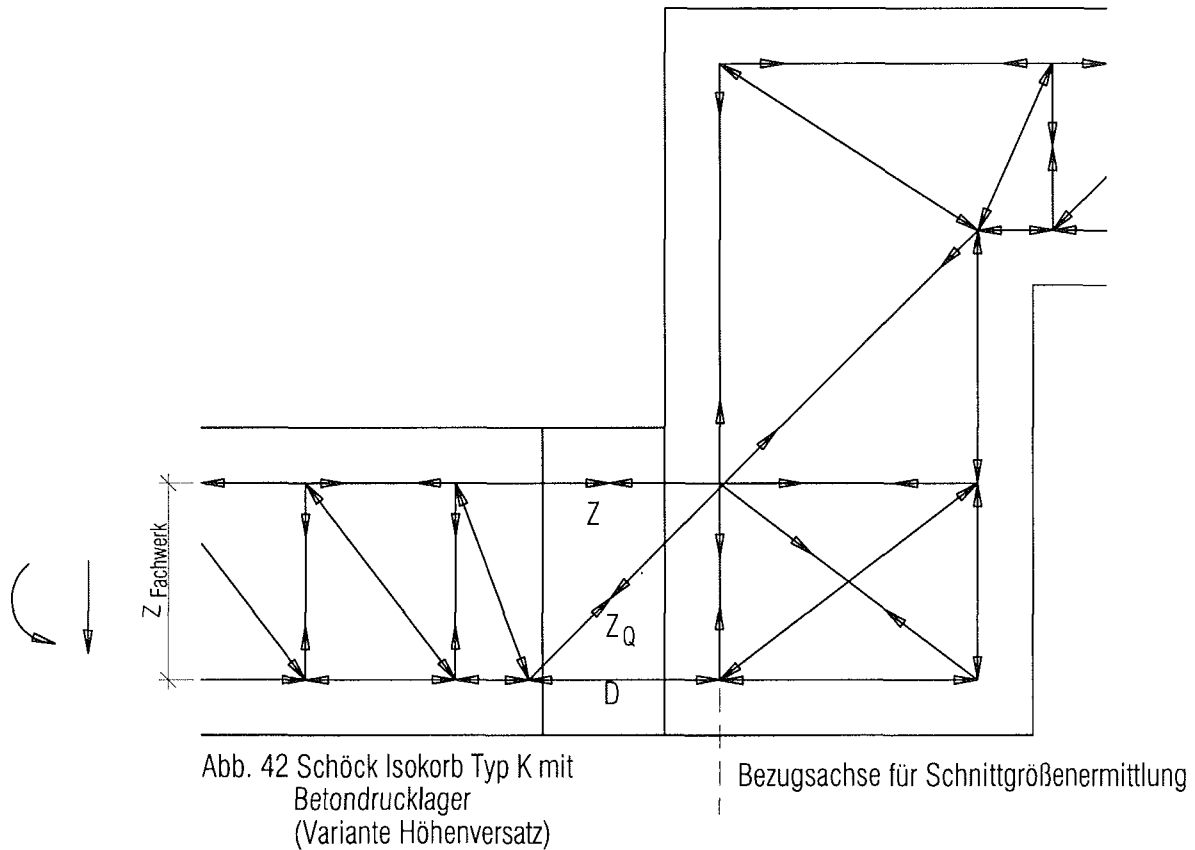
Schöck Isokorb Typ K mit Betondrucklager (Variante Höhenversatz)
